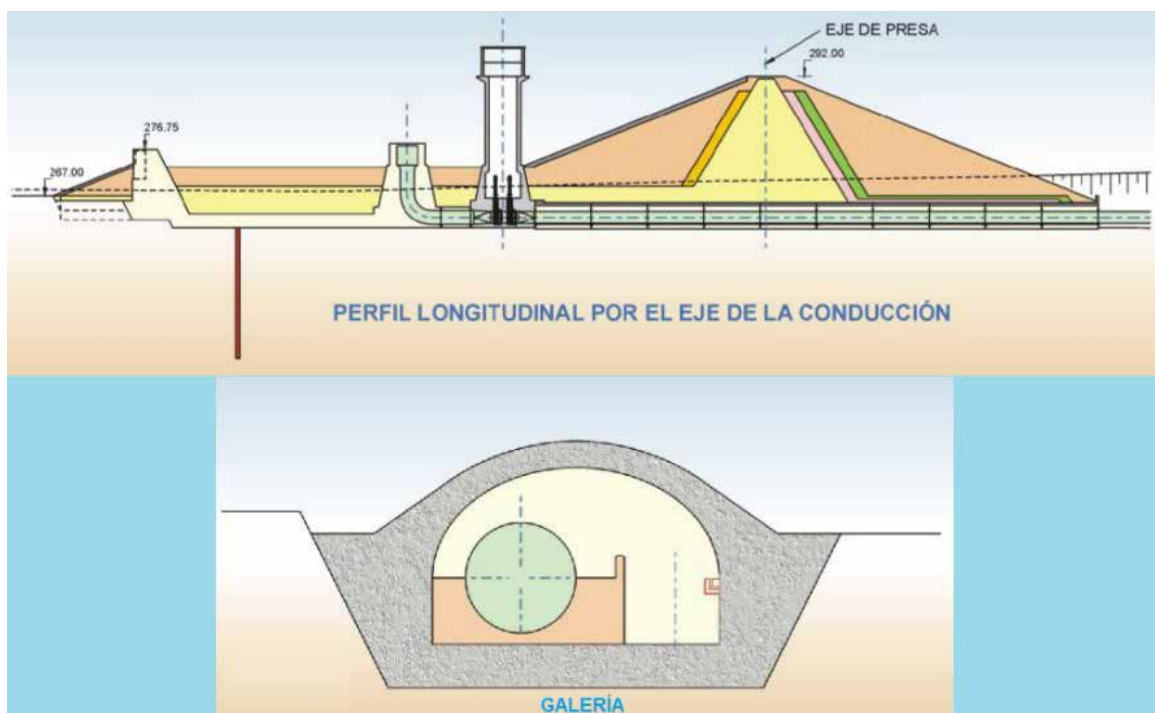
Galería del desagüe de fondo, presa La Loteta. Fuente: SEPTEM (2004)
